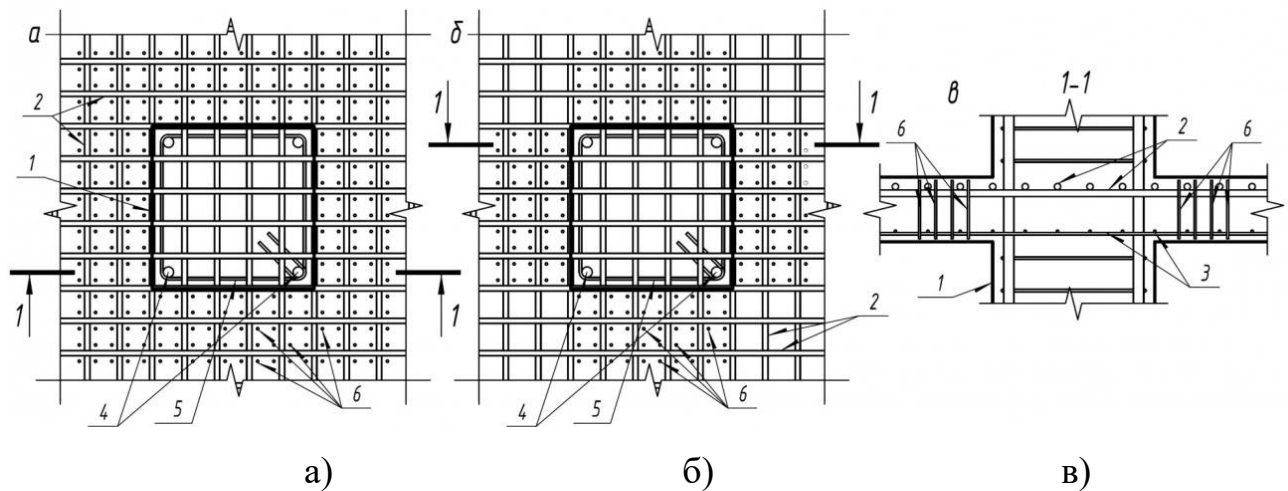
Вузол з'єднання колони з безбалковим монолітним безкапітельним перекриттям:
